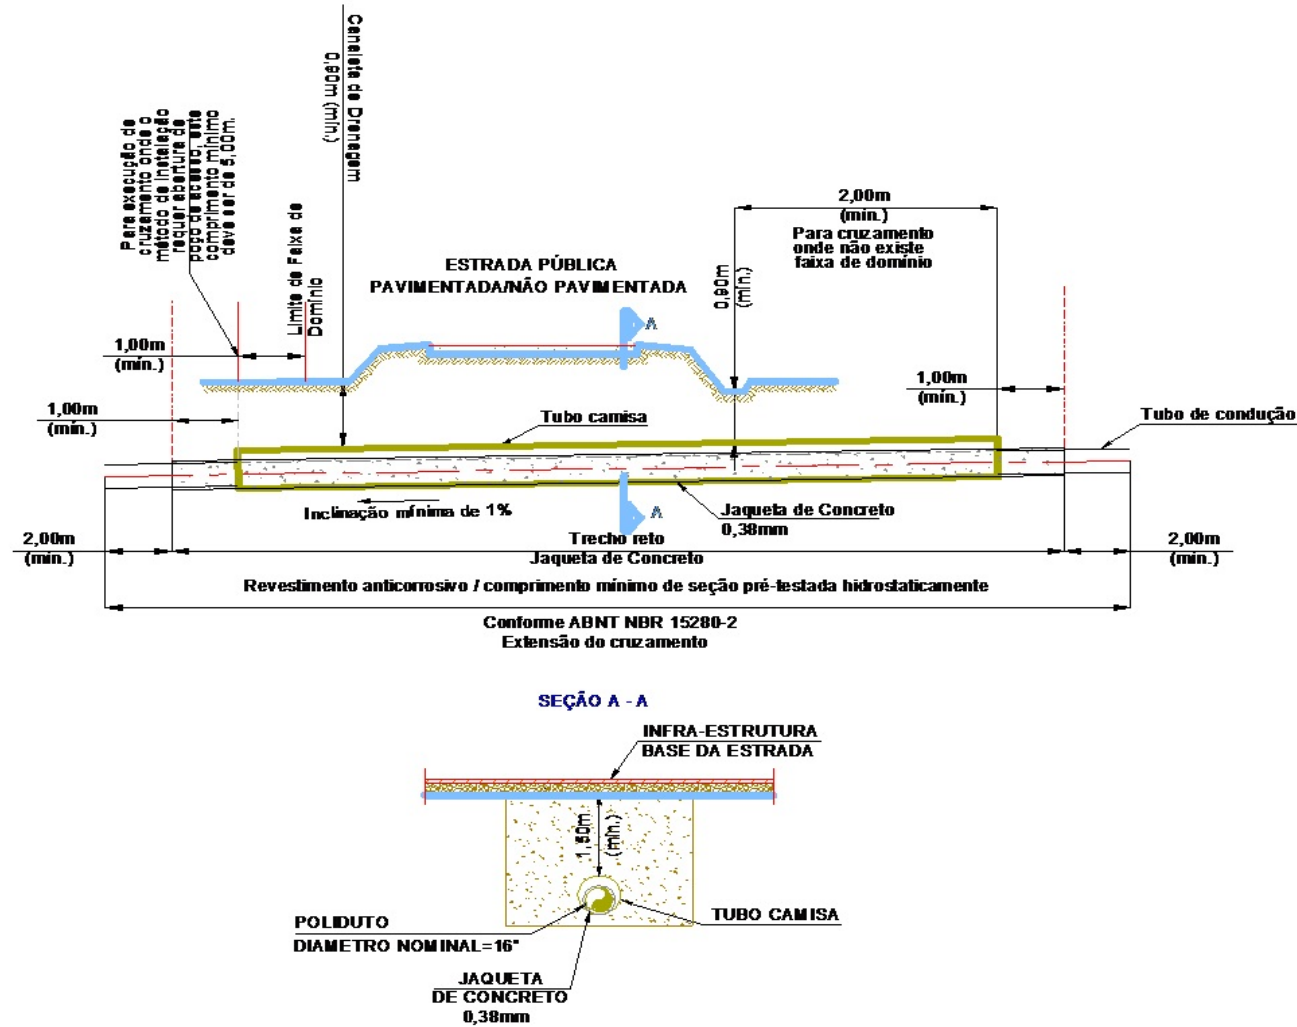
Detalhe Típico Cruzamento – Estrada Pavimentada / Não Pavimentada (Boring machine).
